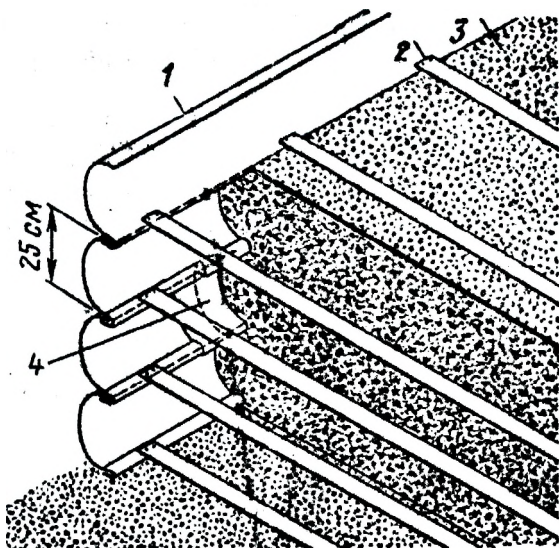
Конструкция подпорной стены из армированного грунта: 1 – металлические штампованные полосы, образующие наружную поверхность подпорной стены; 2 – закладываемые в грунт металлические полосы, удерживающие подпорную стену; 3 – засыпка стены; 4 – перекрытие полос на стыках
